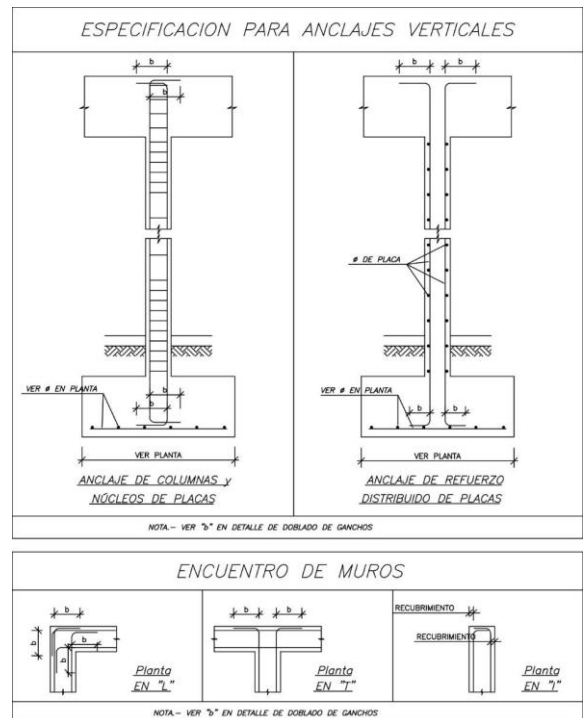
Bloques estructurales del sector Educación. Elaboración propia. Información
